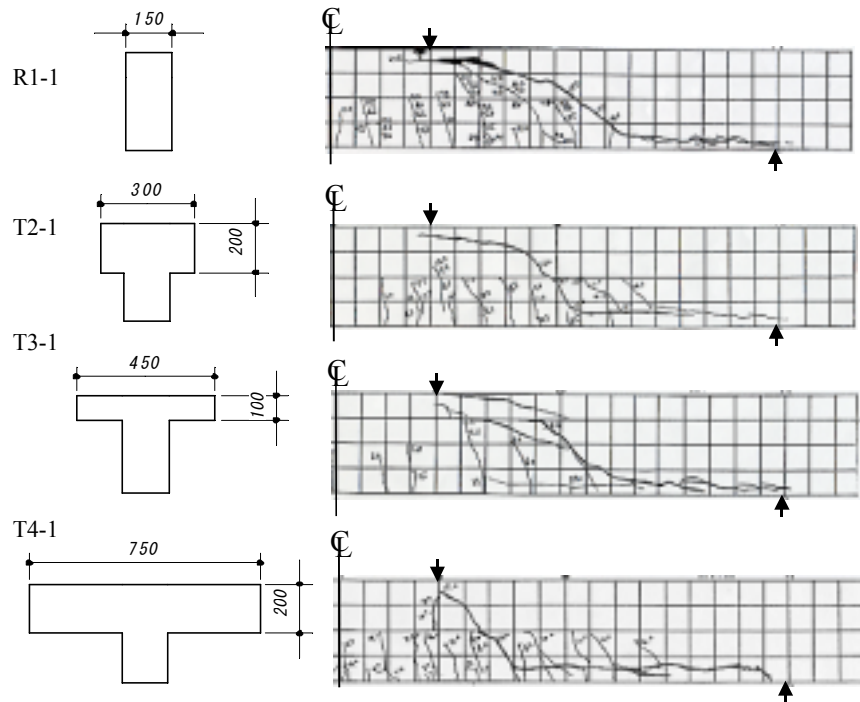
ひび割れ状況 ($a/d=4.0$)
